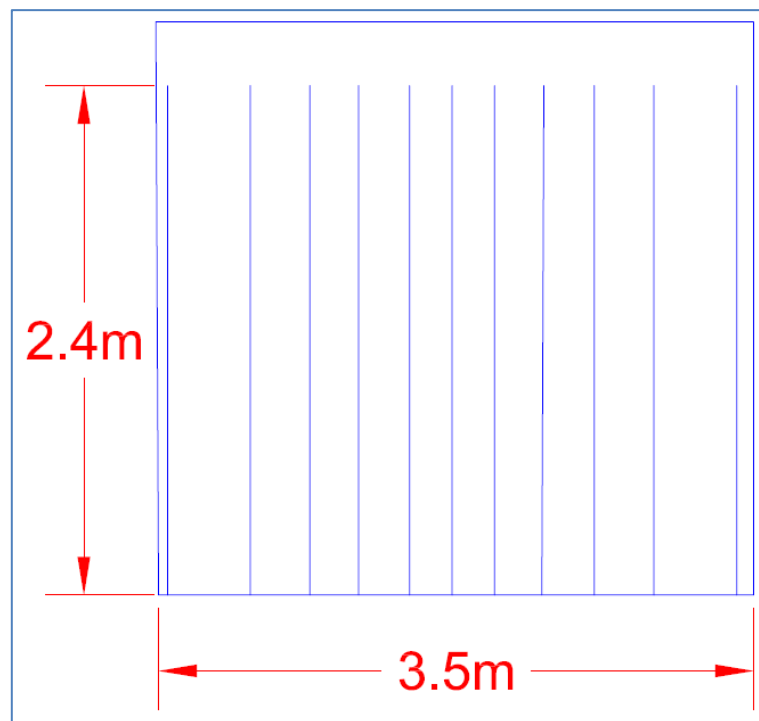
Diagrama de disparo sección 3,5[m]x3,5[m], vista en planta
